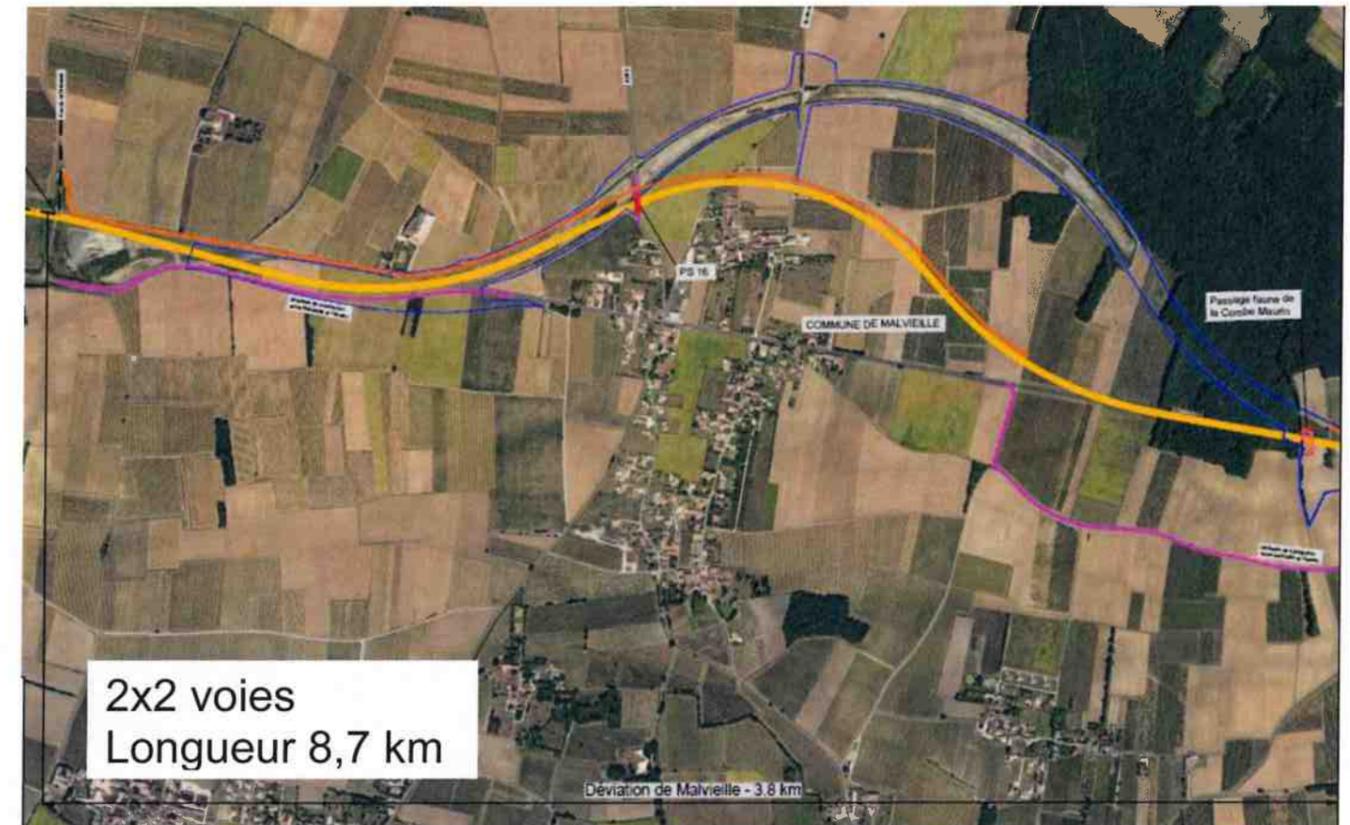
Plan variante avec déviation courte de Malvieille et aménagement sur place de Hiersac
